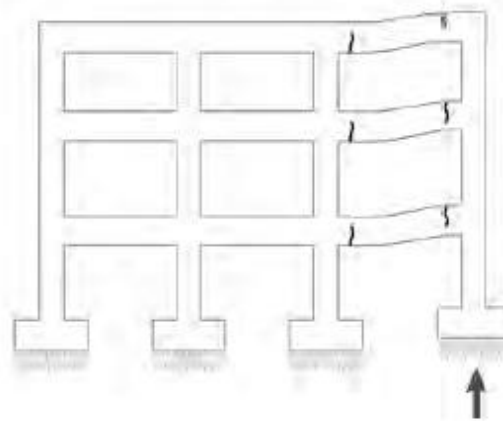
Fisuración por ascenso de columnas de fachada
